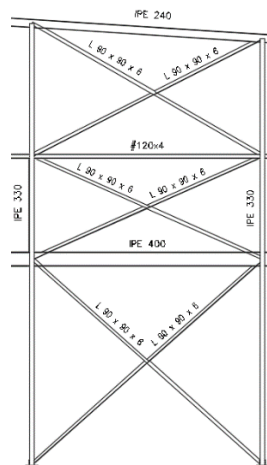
Arriostramiento Pórtico de Fachada F. (Fuente: Cype 3D)
